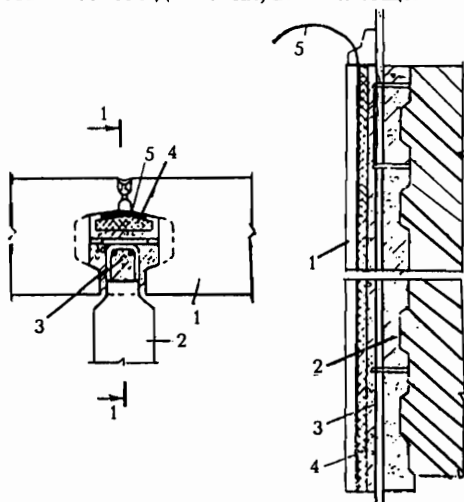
Сопряжение наружных стеновых панелей и плит перекрытия: 1 - наружная стеновая панель; 2 - плита перекрытия; 3 - шпонка; 4 - закладная деталь; 5 - арматурный выпуск; 6 - горизонтальная напрягаемая арматура
